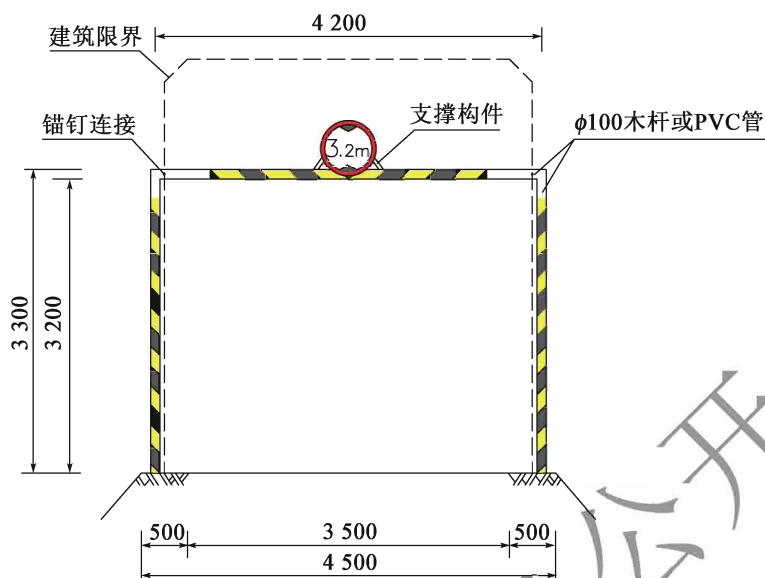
防撞限高架结构示意图二(尺寸单位: mm)
